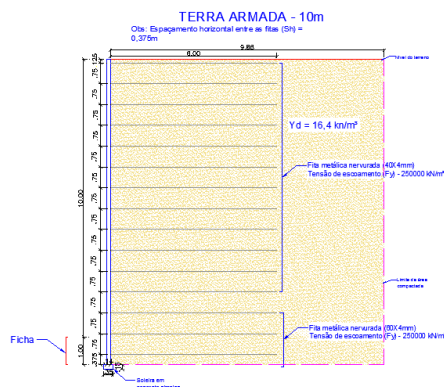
Corte transversal da estrutura de contenção em terra armada, 10 m.
